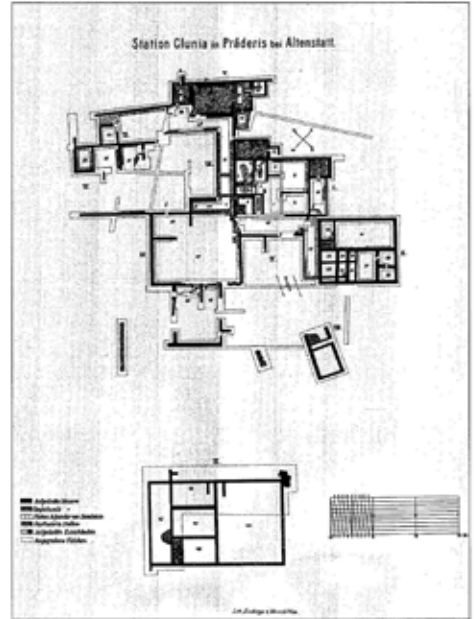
Feldkirch-Altenstadt. Grundrissplan der 1883/84 ausgegrabenen römischen Gebäude. Nach Jenny 1888.
